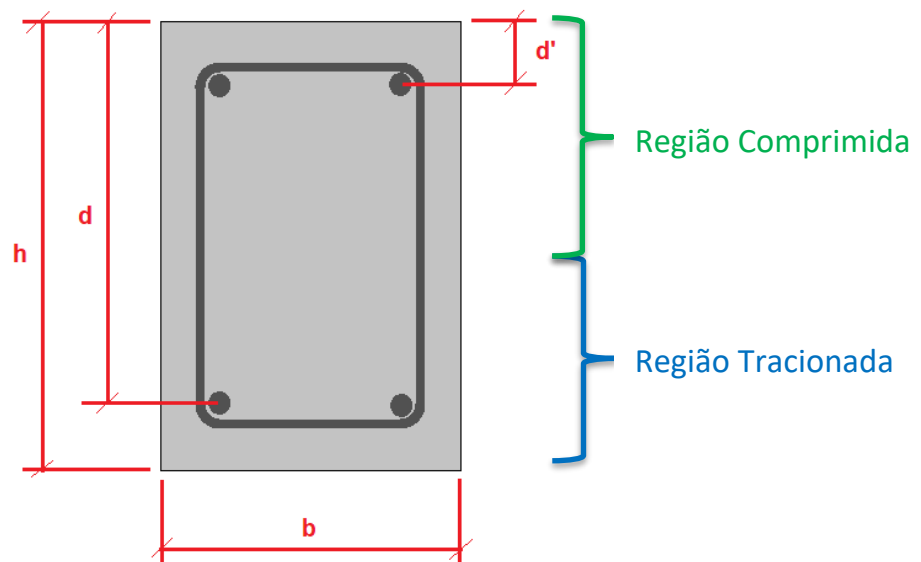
Características geométricas de uma seção transversal de um elemento de concreto armado.
